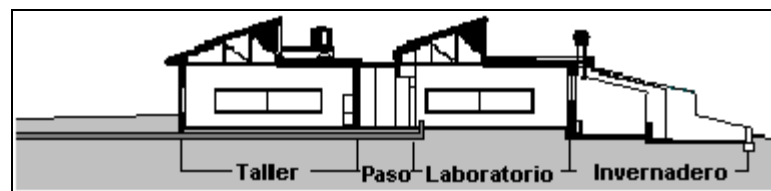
Corte del edificio en un plano que pasa por el taller.
